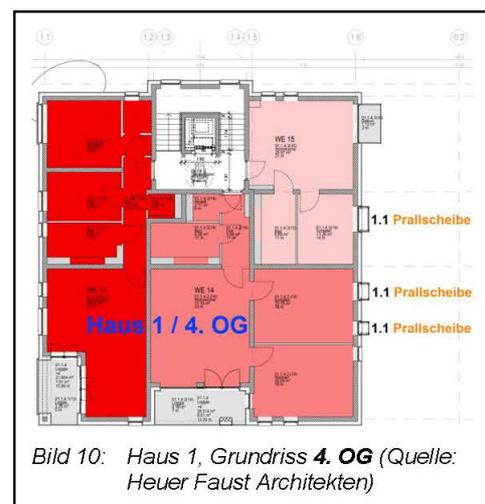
Haus 1, Grundriss 4. OG (Quelle: Heuer Faust Architekten)
